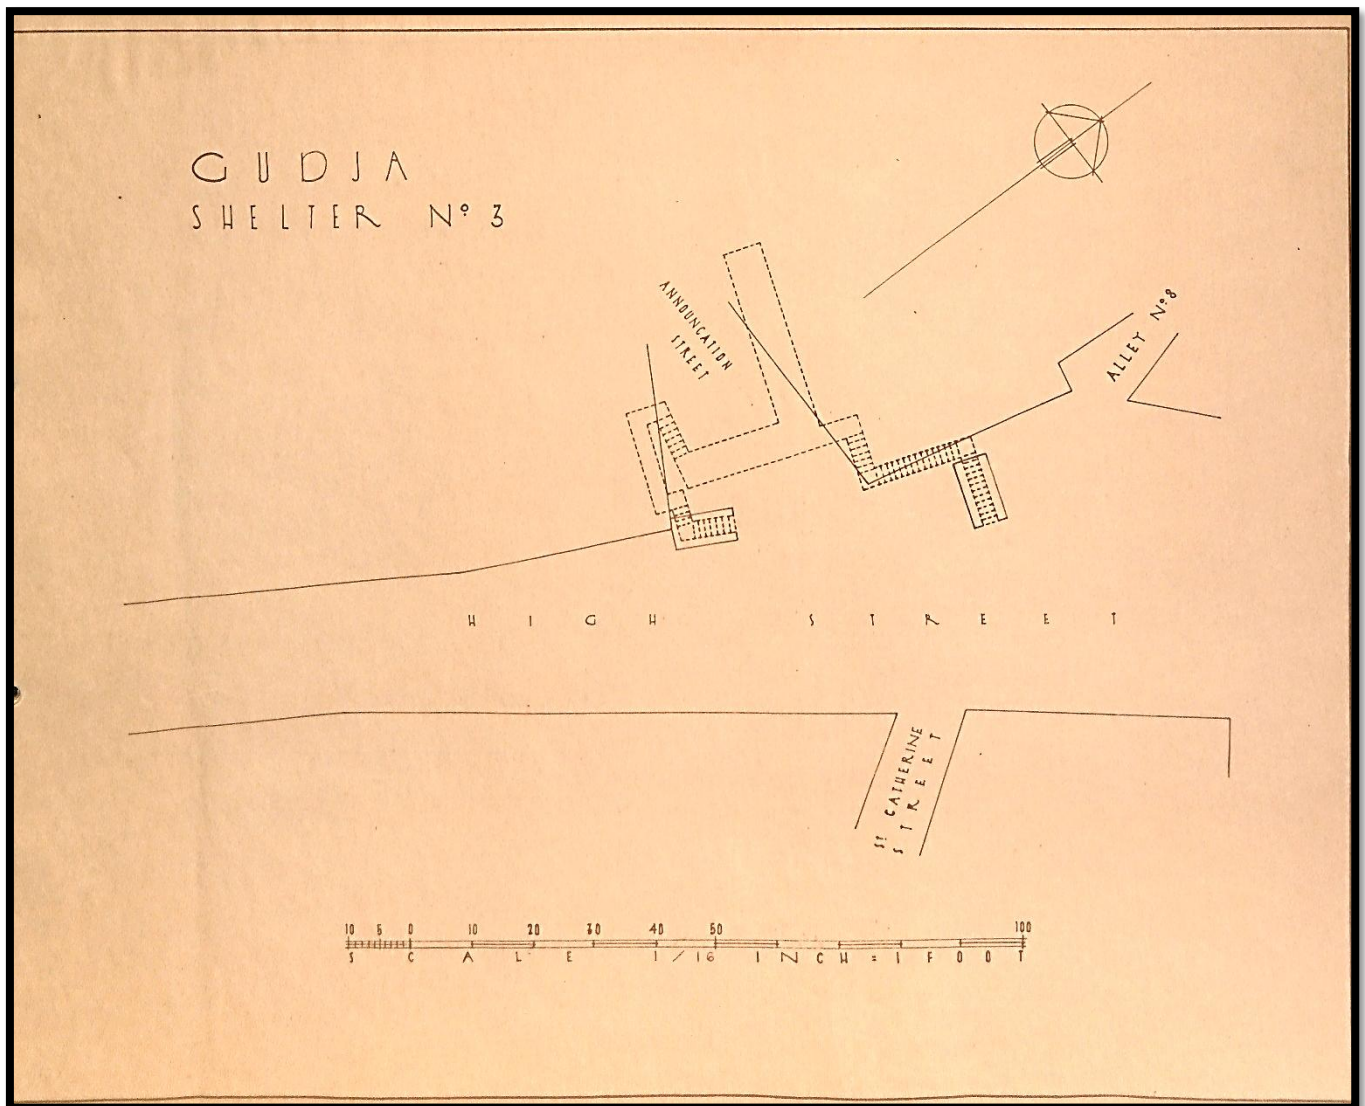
Planta do Abrigo nº3 "Annunciation Street – High Street – Alley nº8."
